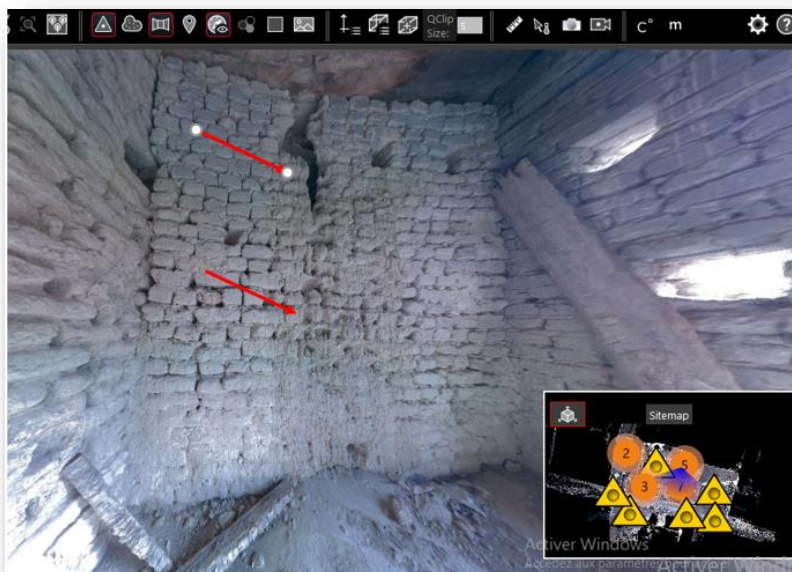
Photo JetStream sur la maison 18, dont le mur présente une fissure passante nécessitant un traitement. Source : Auteure.2022.
